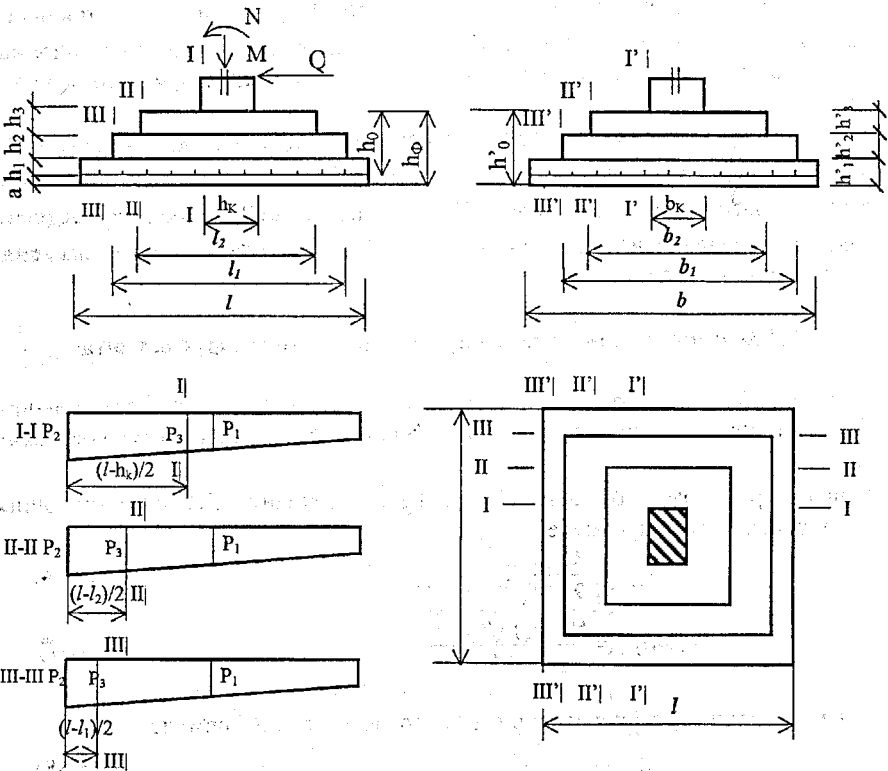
Расчетные схемы для определения подошвы фундамента
